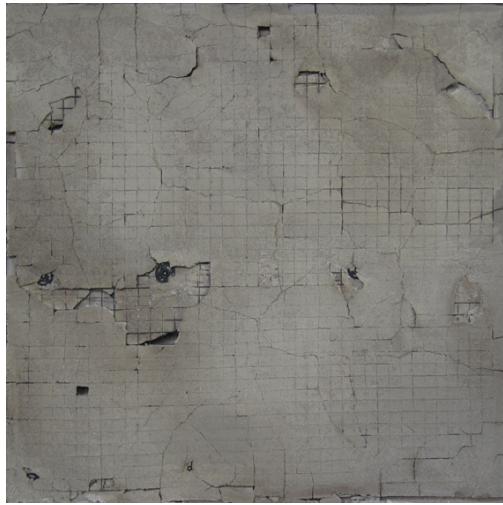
耐火試験後の状況 (No. 7) [P6]
